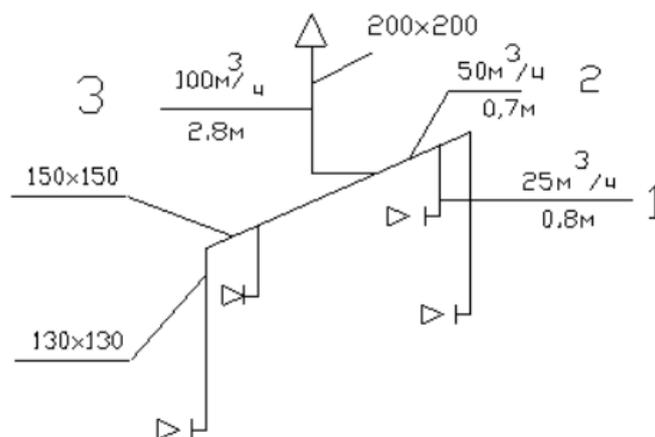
Расчетная аксонометрическая схема системы вытяжной вентиляции 2-х этажного жилого дома
